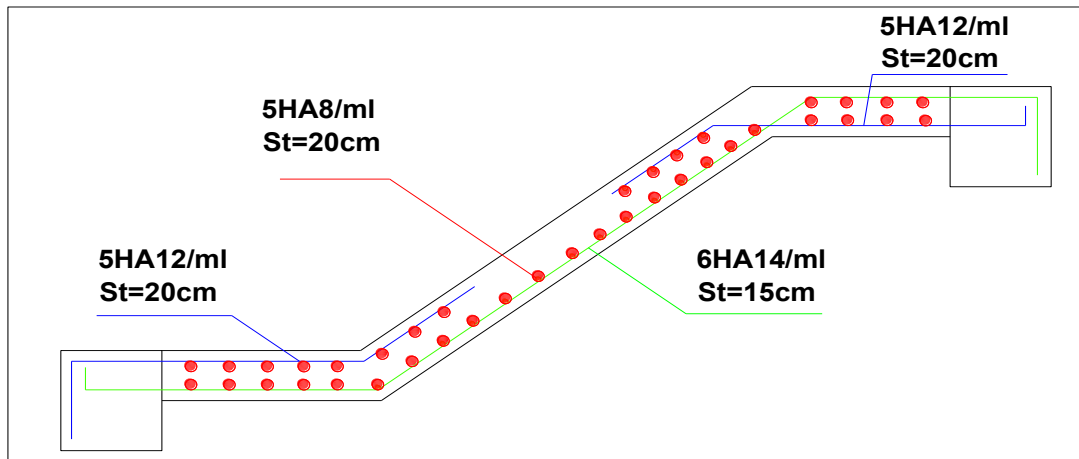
Schéma de ferrailage de l'escalier à deux volées.
